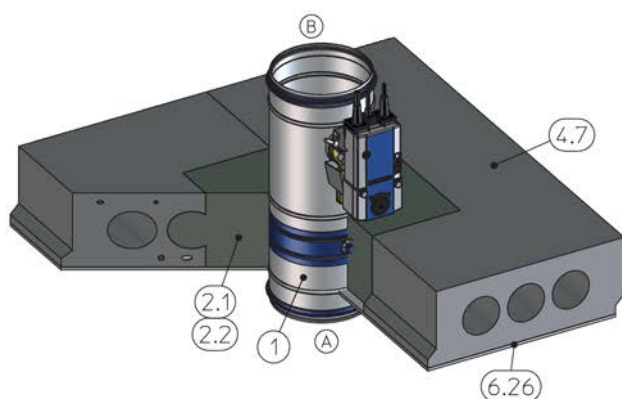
Монтаж с применением строительного раствора в перекрытиях из пустотных блоков, на рисунке показано вертикальное расположение (также применимо для монтажа на подвесах)
